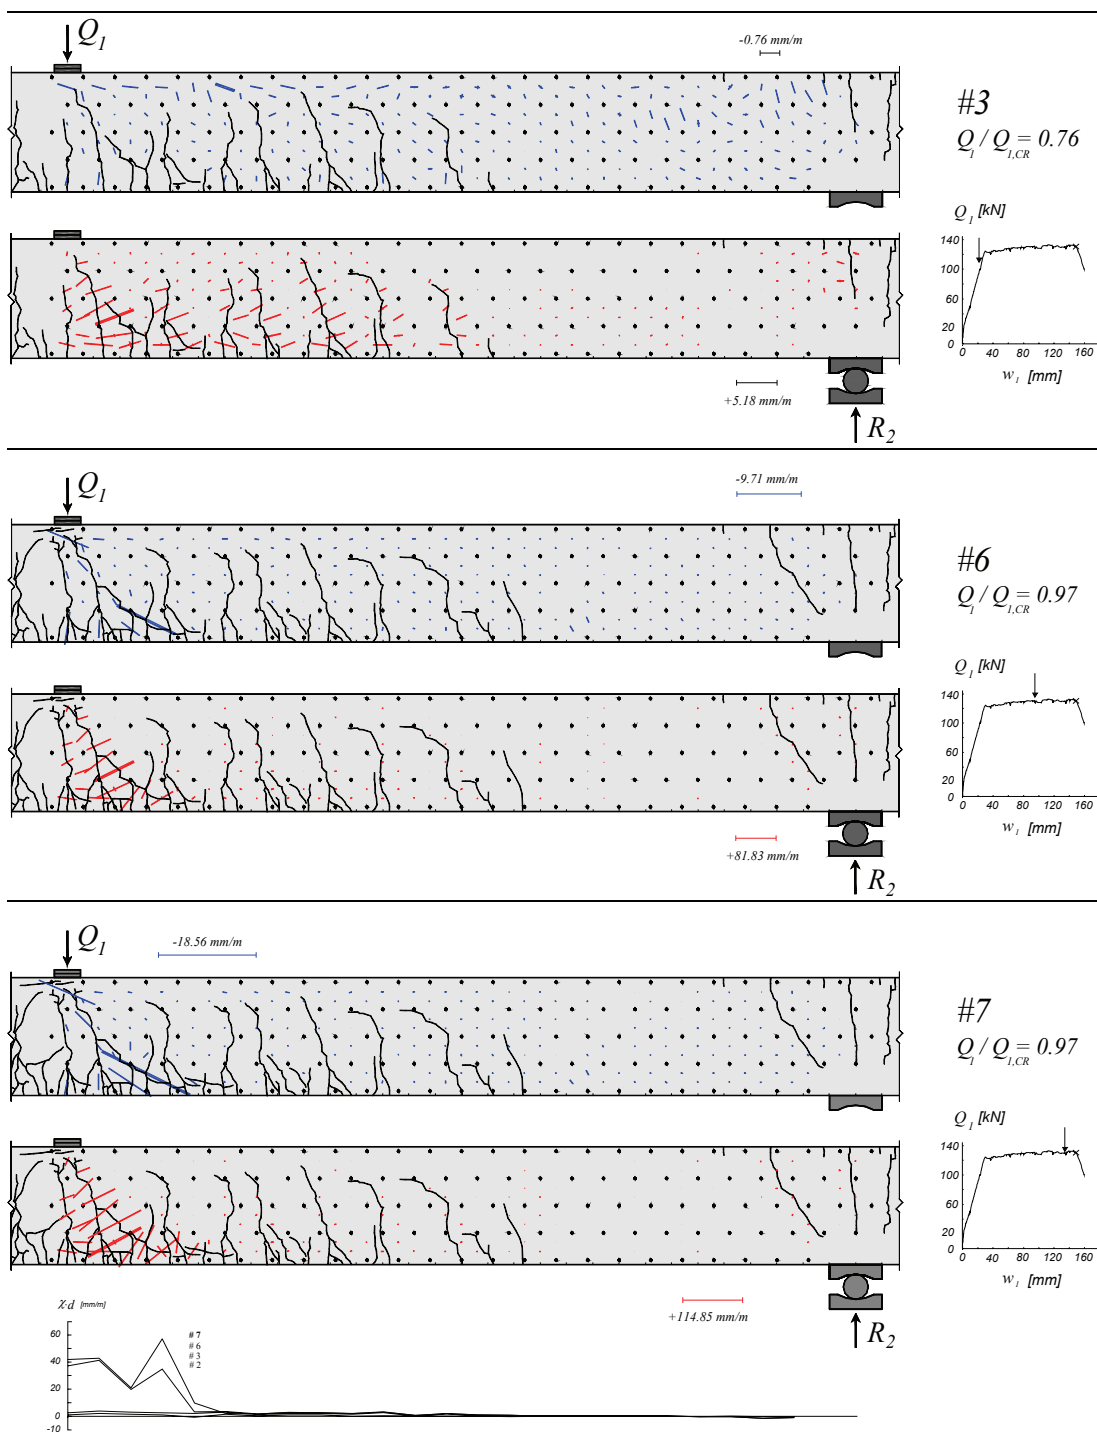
Poutre SR12: déformations principales, fissuration et courbures
